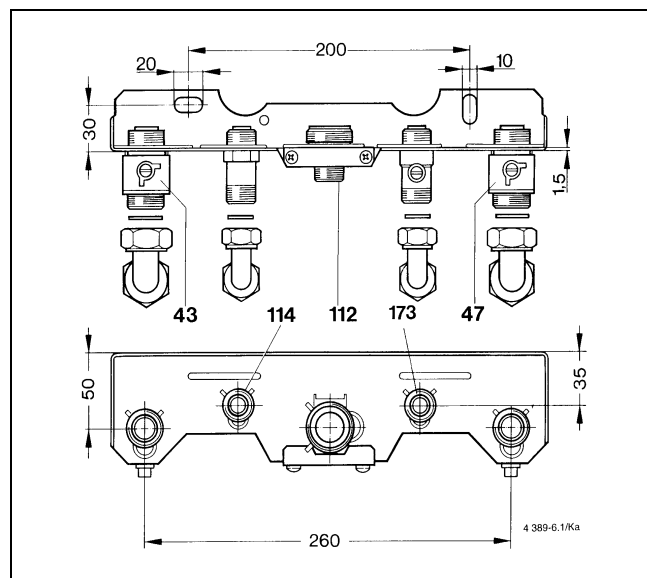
Plaque du montage pour le raccordement (accessoires)
